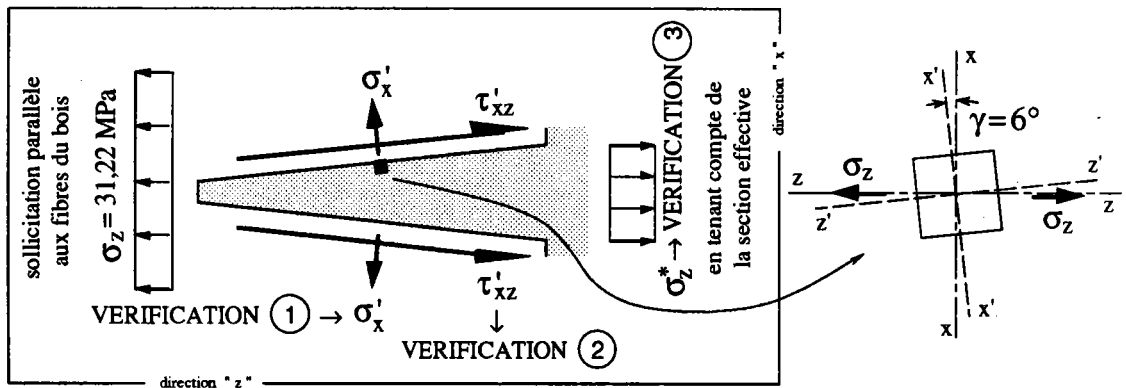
Section suivant un plan parallèle aux fibres du bois de la pièce de coin en contenant la section longitudinale des entures.
